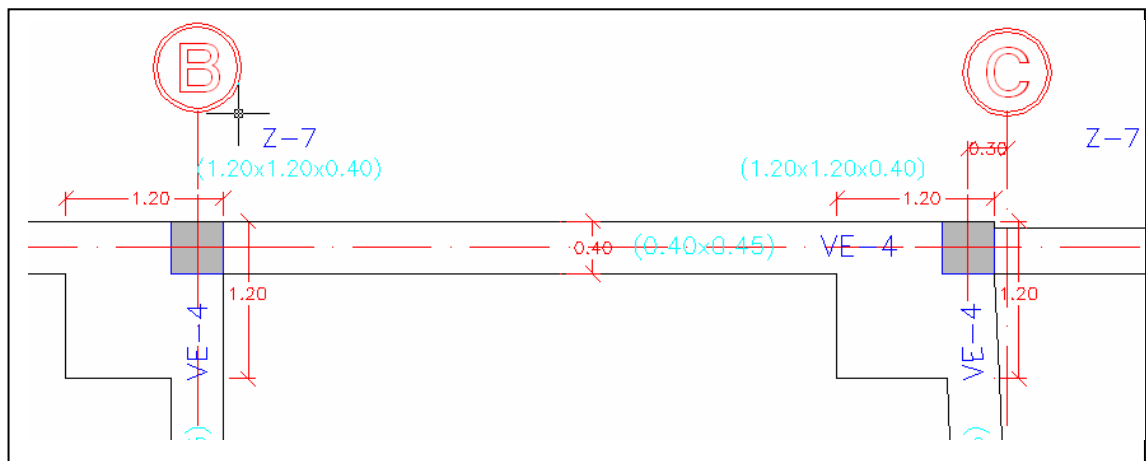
Desplazamiento de zapata a causa de cimentación existente.
